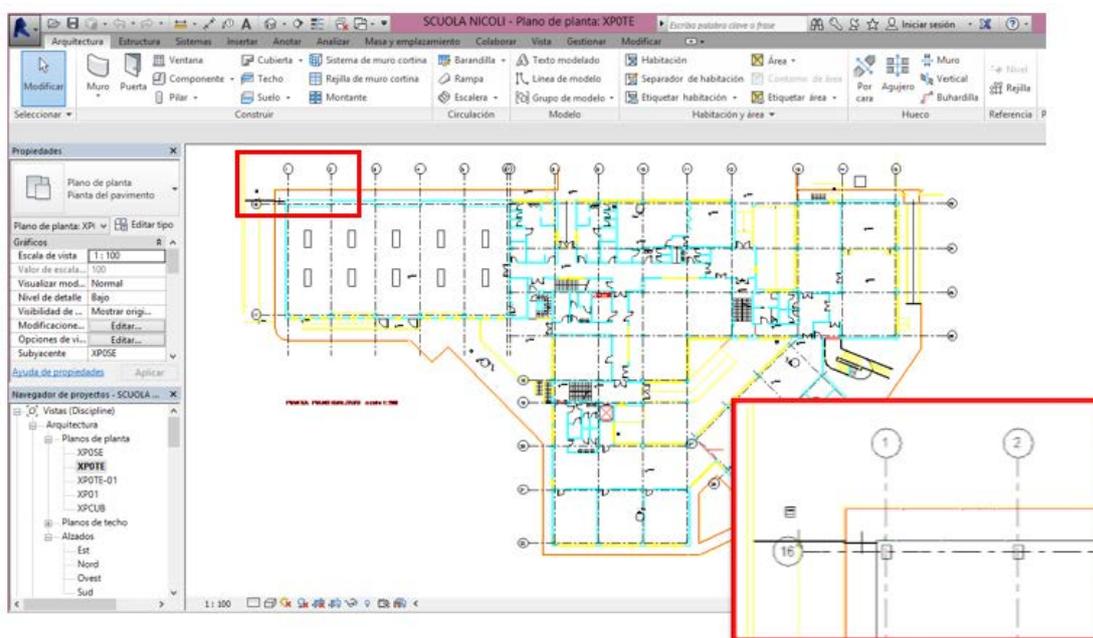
Inserimento pilastri nel progetto (Fonte propio)
